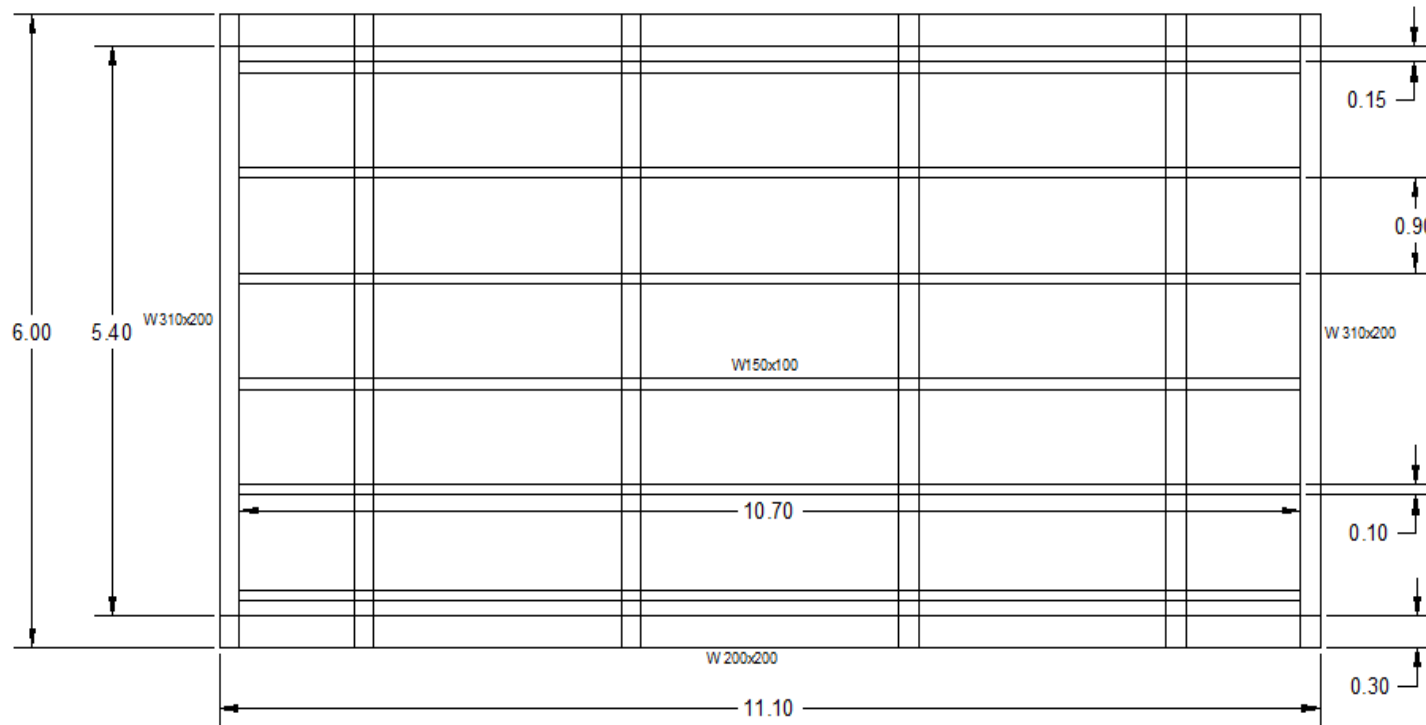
Armadura promedio de paso inferior. Vigas metálicas.
